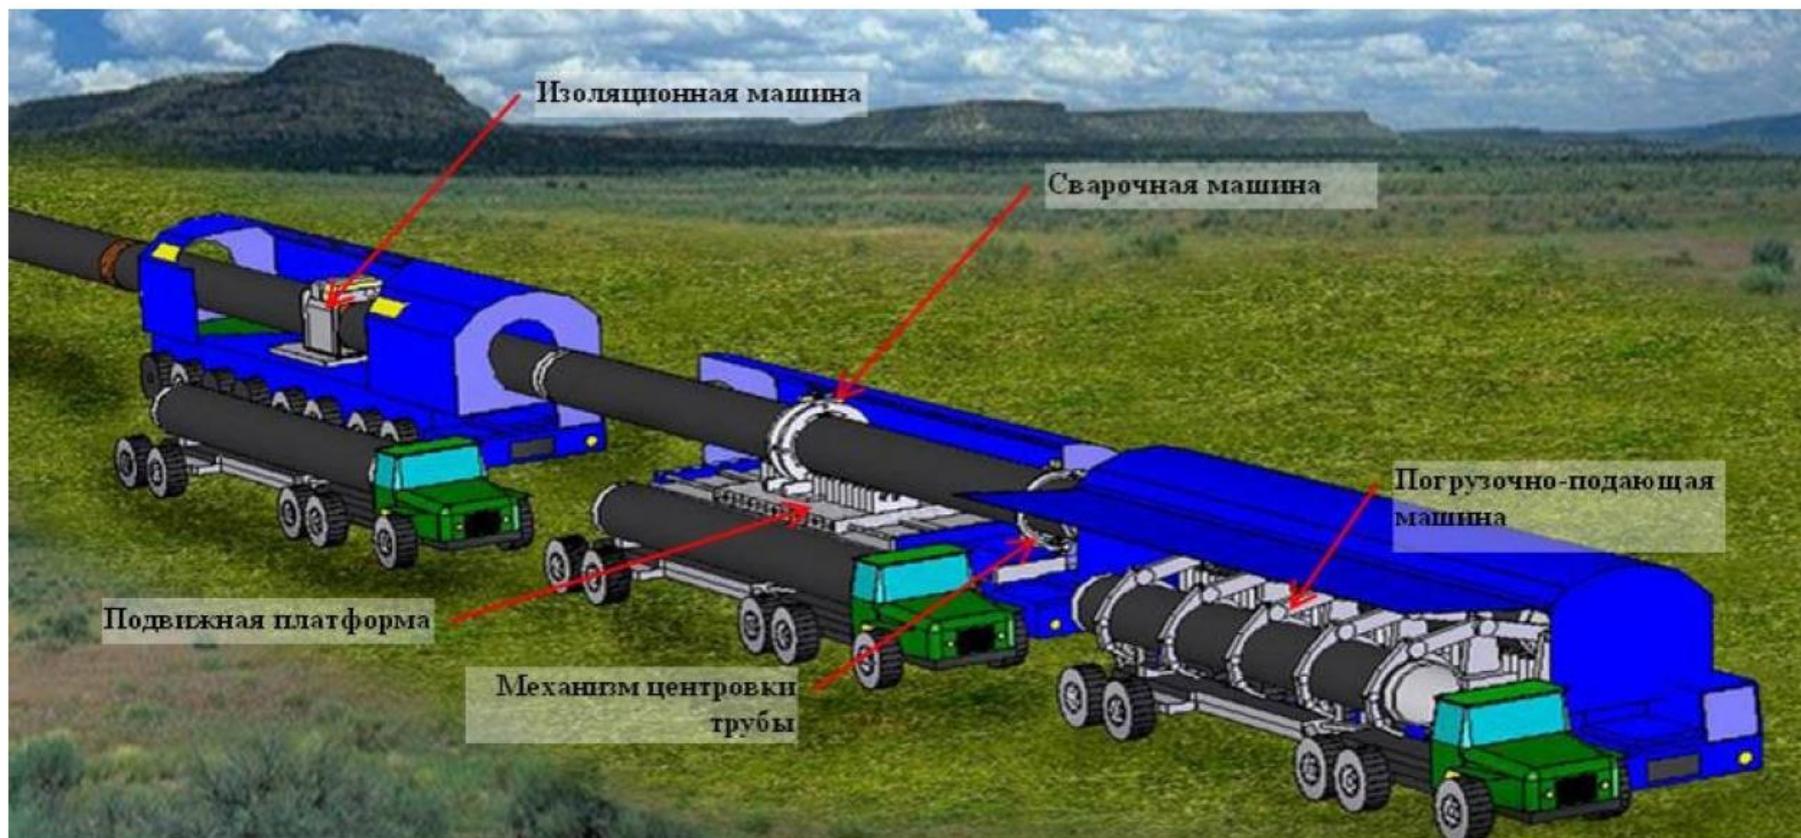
Автоматизированный мобильный комплекс для лазерной сварки газопроводных труб в полевых условиях
